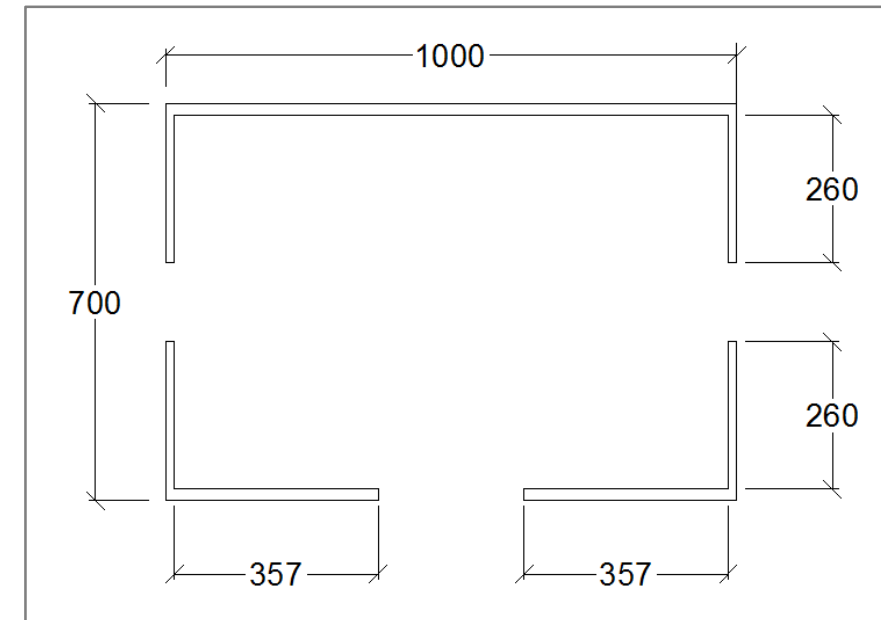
Sección reducida por axil de compresión en vigas longitudinales de calzada (cotas en mm)
